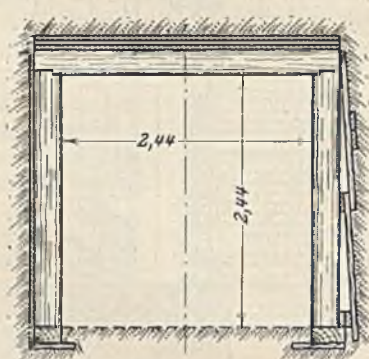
Wasserleitungstunnel. Zimmerung in nicht tragendem Gebirge.
